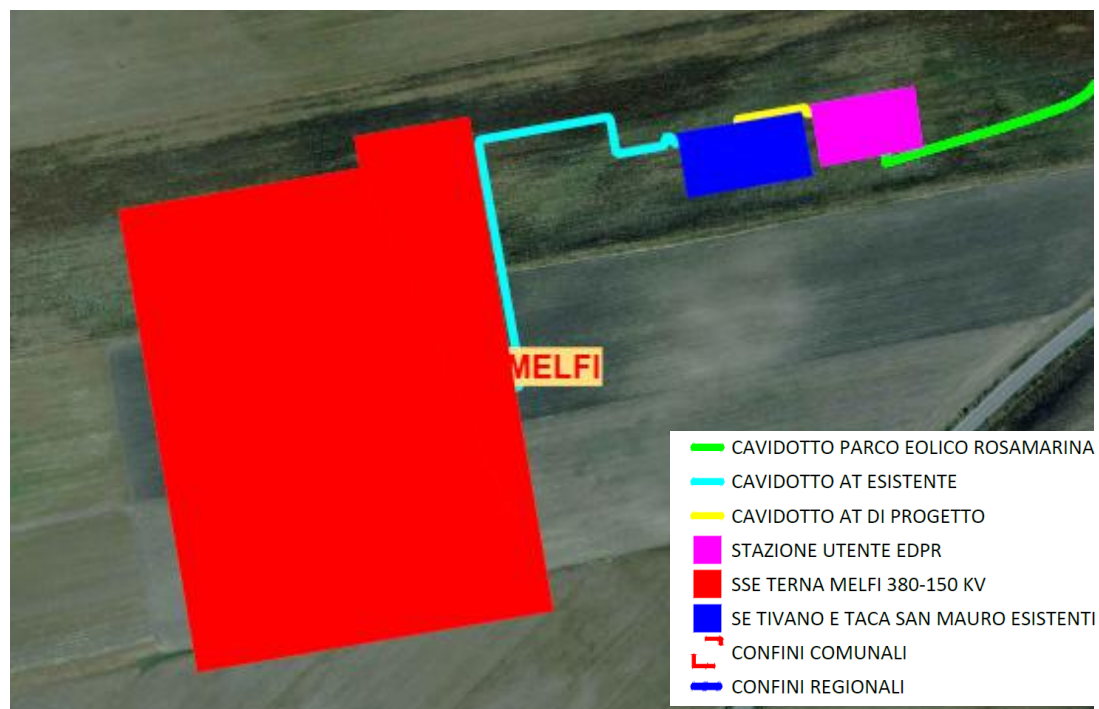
Stralcio planimetrico area sottostazione nel territorio comunale di Melfi in Località Masseria Catapaniello
